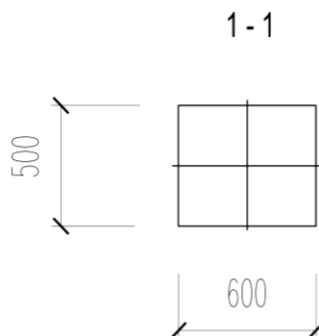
Поперечний переріз надкранової частини колони
